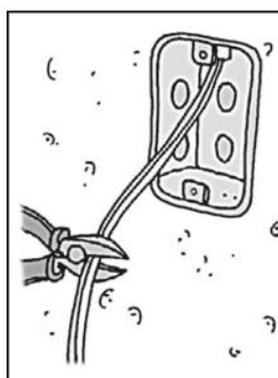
Corte necesario en caja para accesorio electrico.
